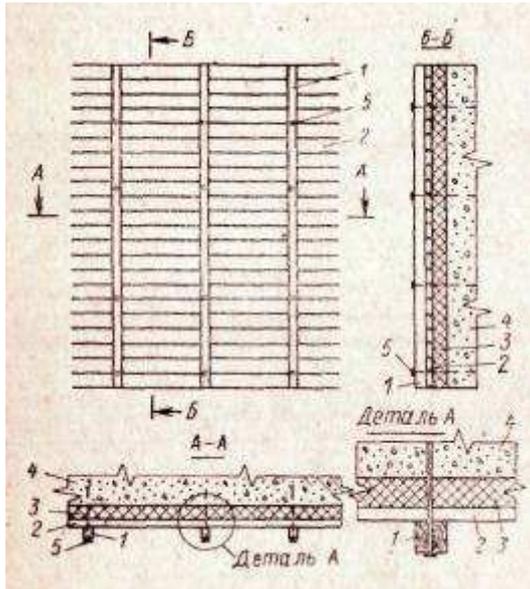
Схема стационарной опалубки асфальтокерамзитобетонной гидро теплоизоляции вертикальной поверхности (к п. 3.37)
